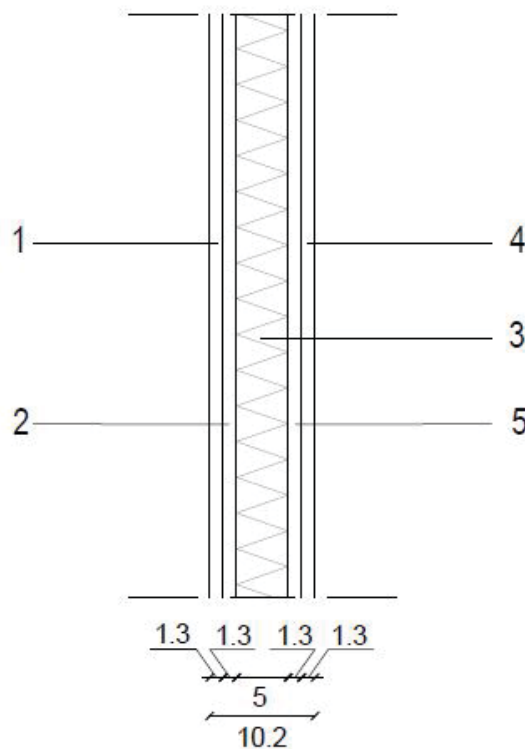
Cubierta 1 y 2 hotel B&B. Fuente: Elaboración propia
